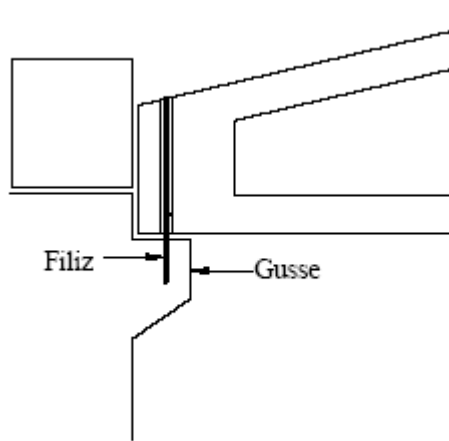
Kısa Konsollu Kolon - Neopren Plak – Kiriş Arasındaki Bağlantı
